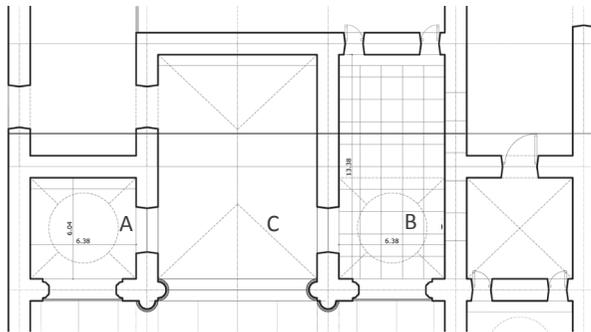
Detalle planta Iglesia de San Jacinto siglo XVIII.
